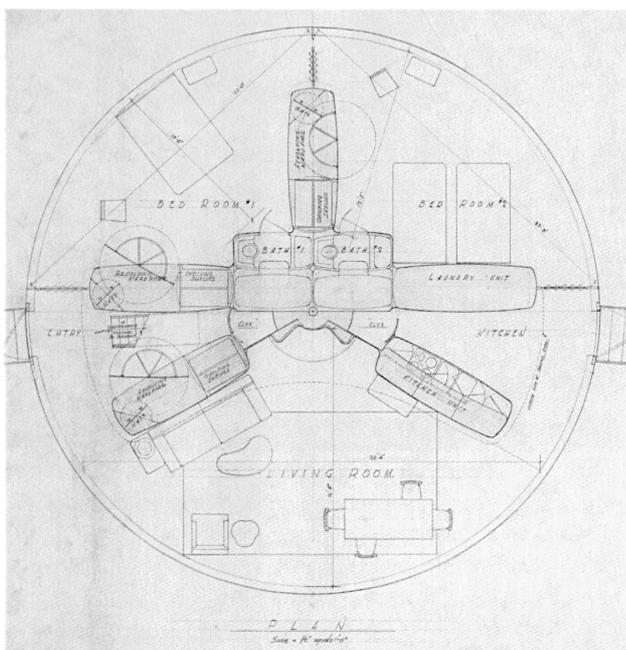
e 16 | Planta e maquete da Wichita House, 1944.
